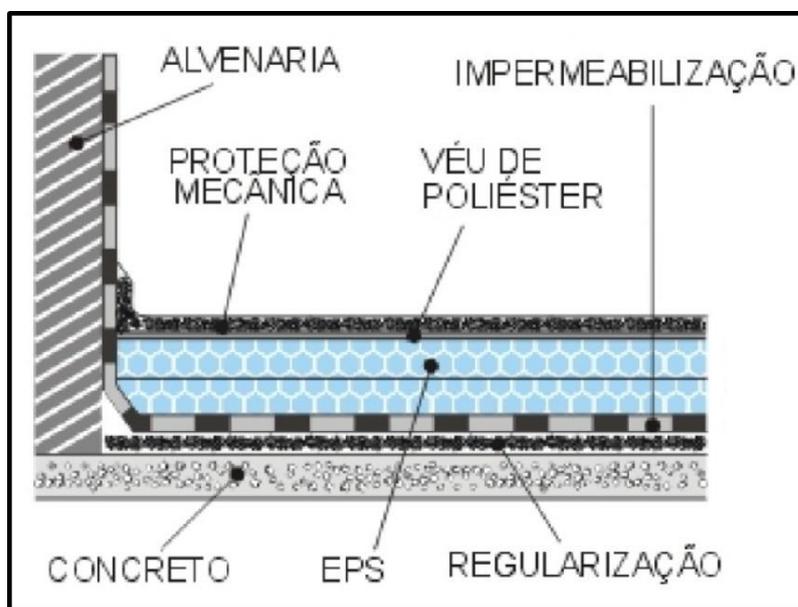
LAJE DE CONCRETO IMPERMEABILIZADA COM ISOLANTE TÉRMICO
